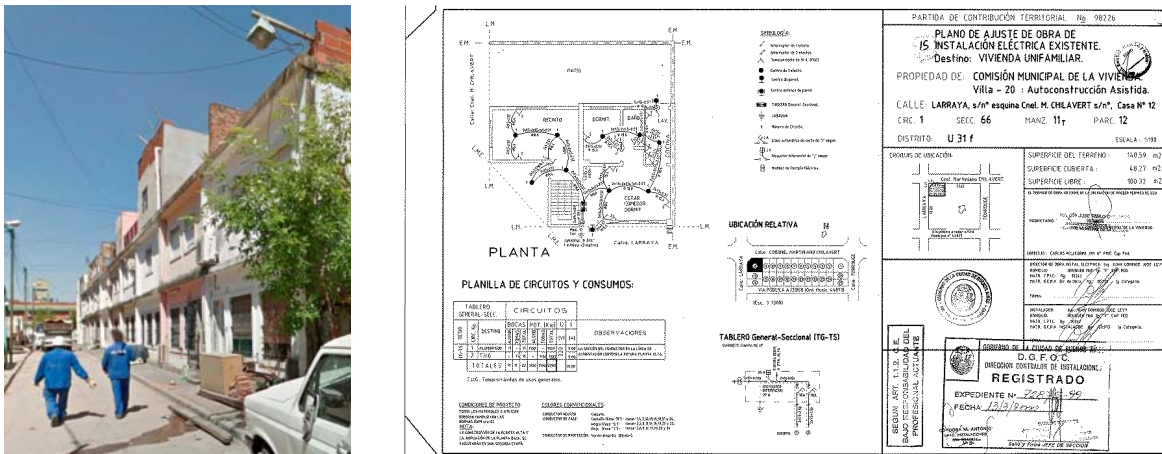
Plano catastral e imagen reciente del conjunto construido por la CMV bajo la modalidad “Autoconstrucción asistida”, en la calle Chilavert al 5300, entre Larraya y Fonrouge, lado sur. Fuente: USIG y G. Earth Street View, captura de noviembre de 2016
